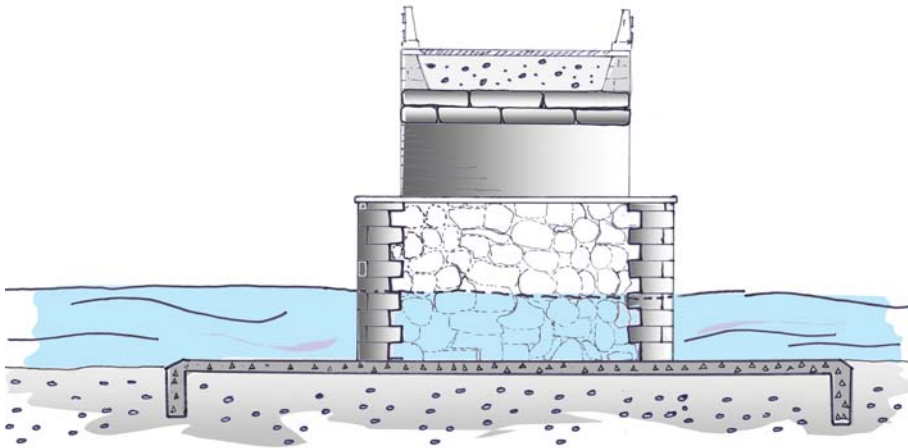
Solera o contrabóveda y rastrillos de hormigón armado.
